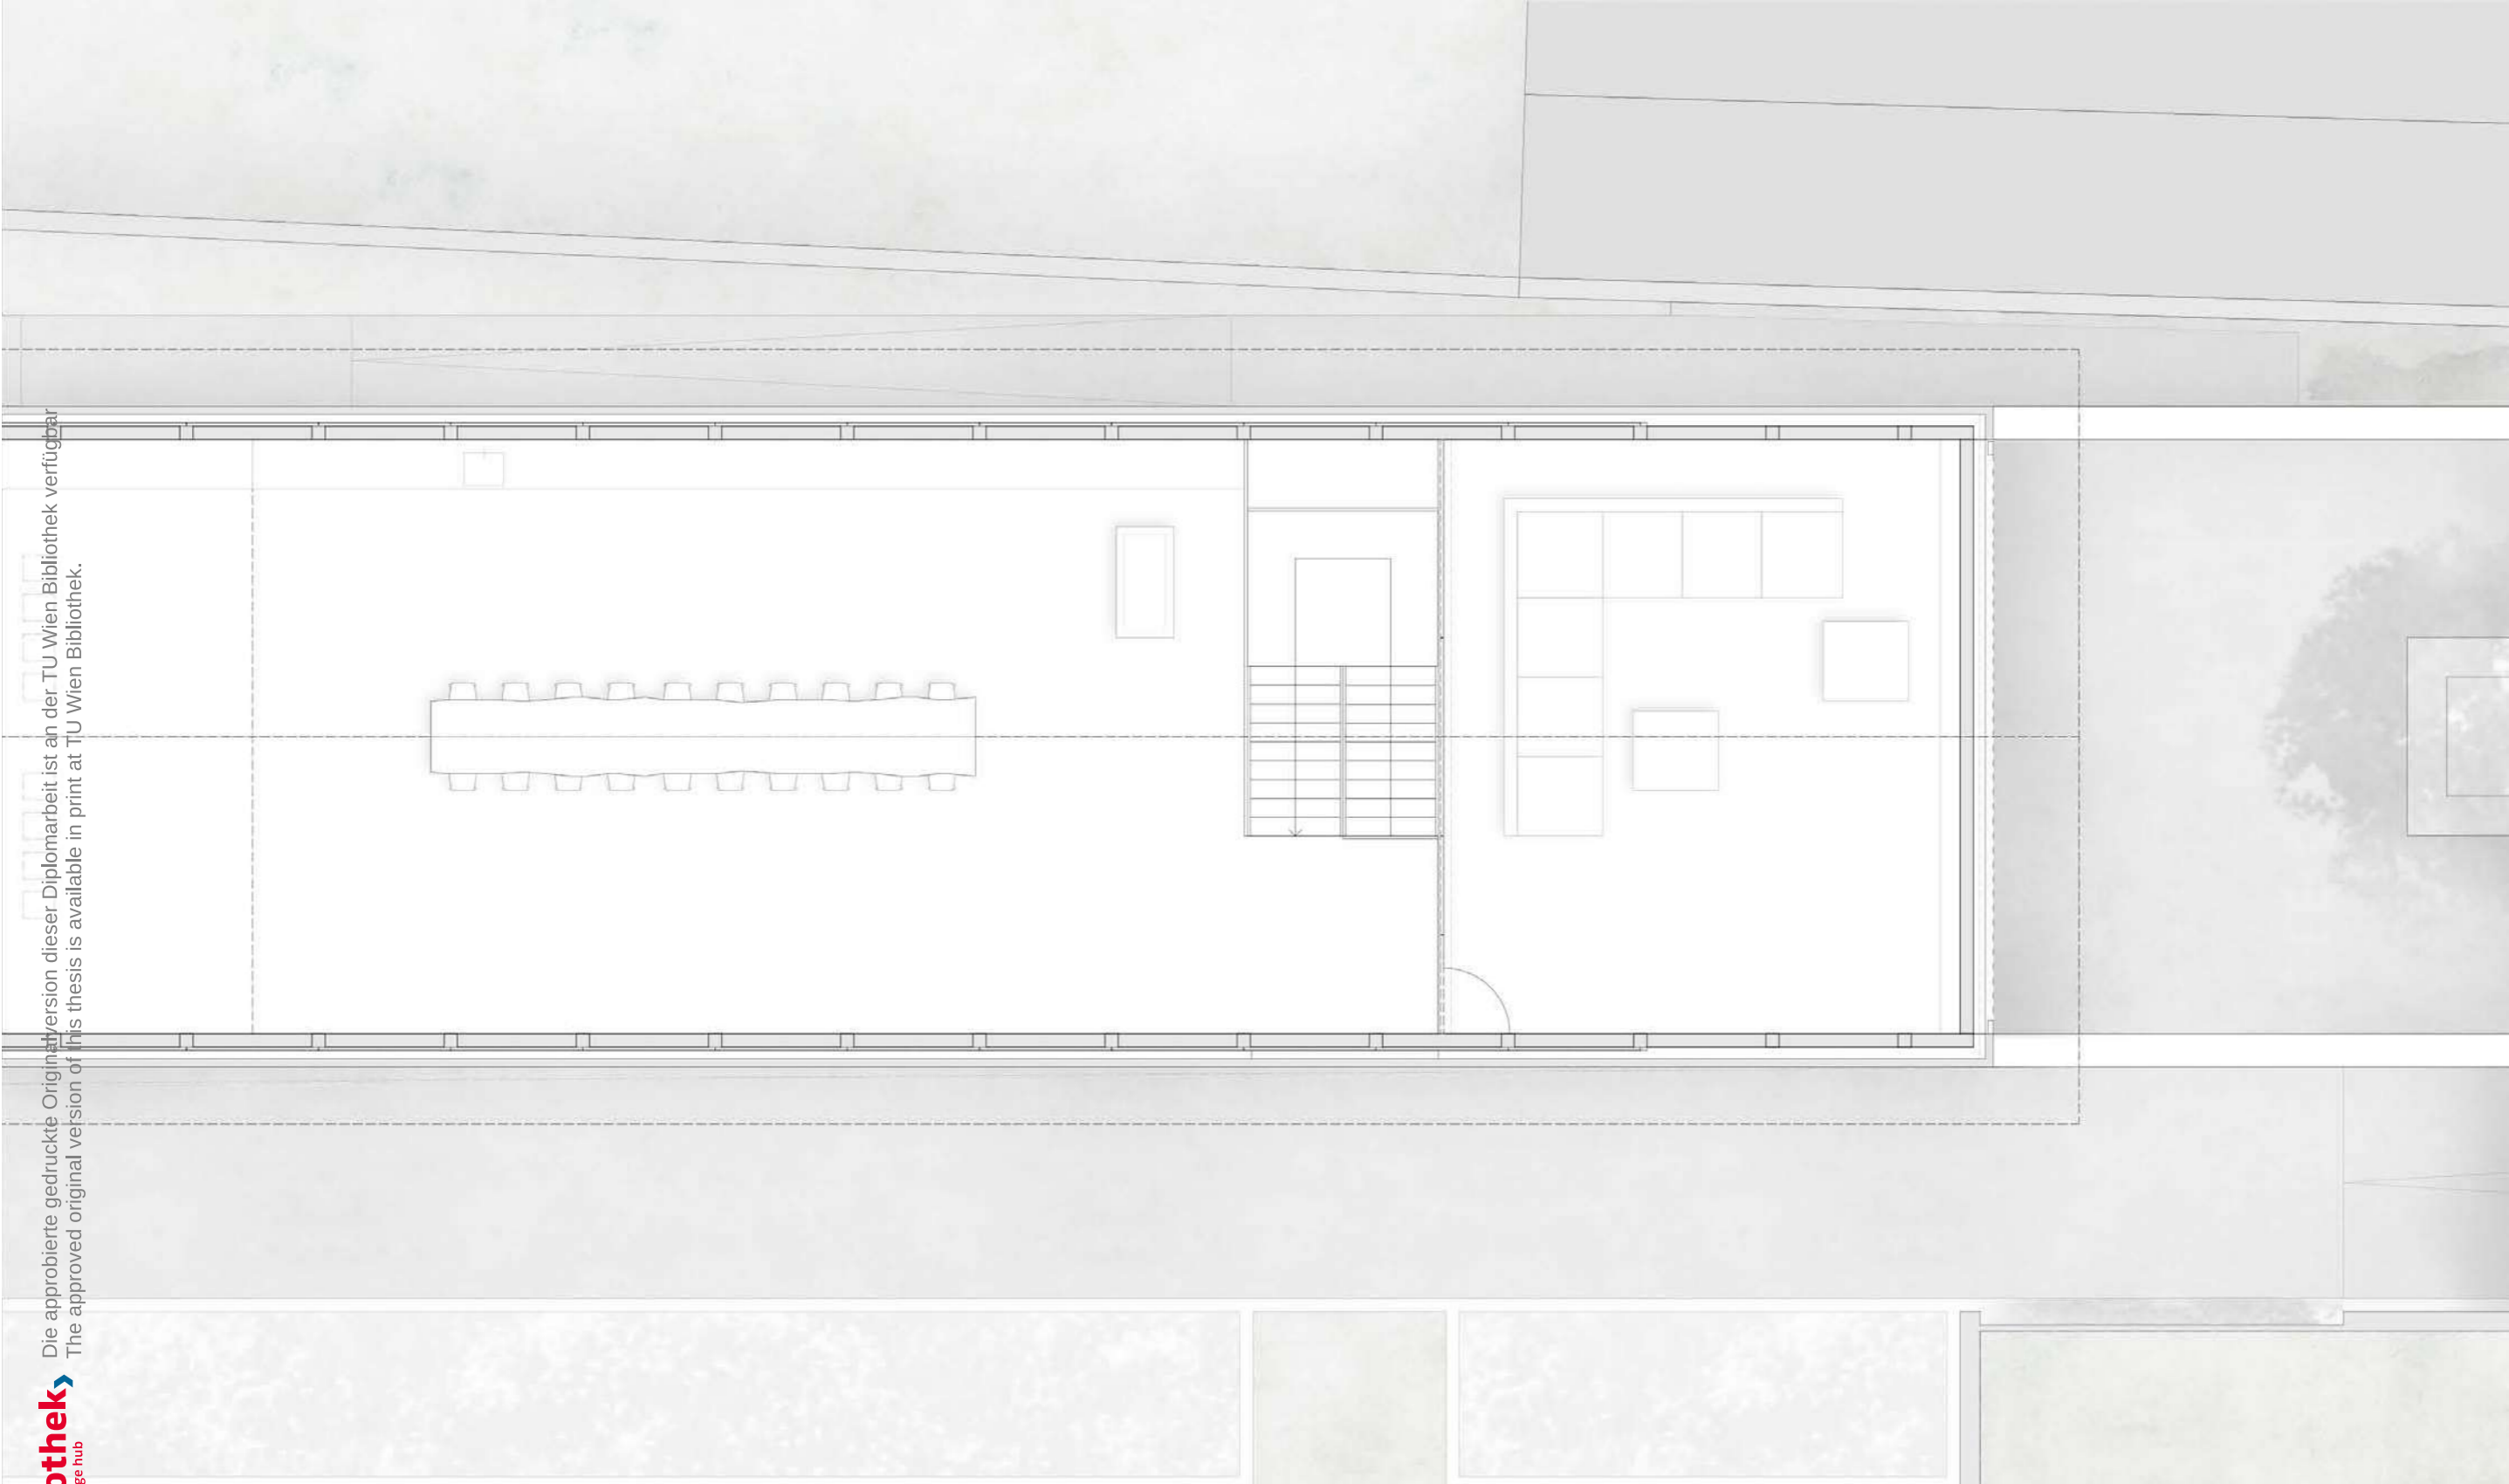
Grundriss Verkostungsraum M 1:100
